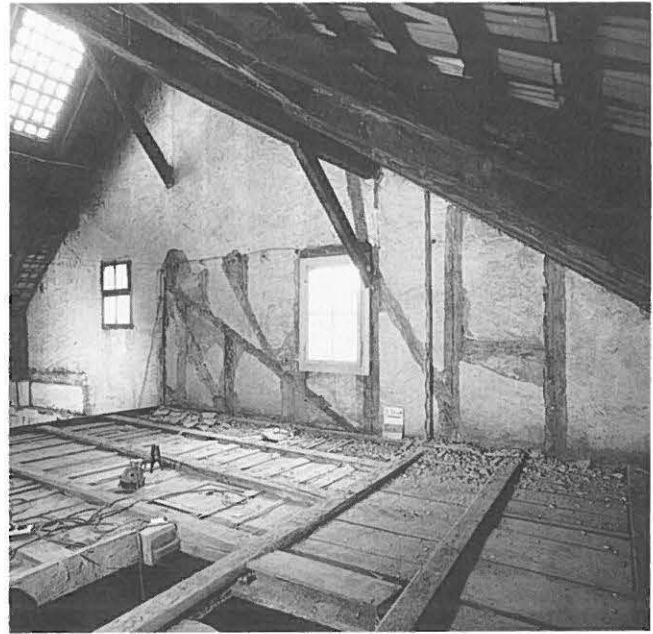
Bälliz 71. Dachraum, Blick nach Nordosten mit älterer Dachlinie (23).
